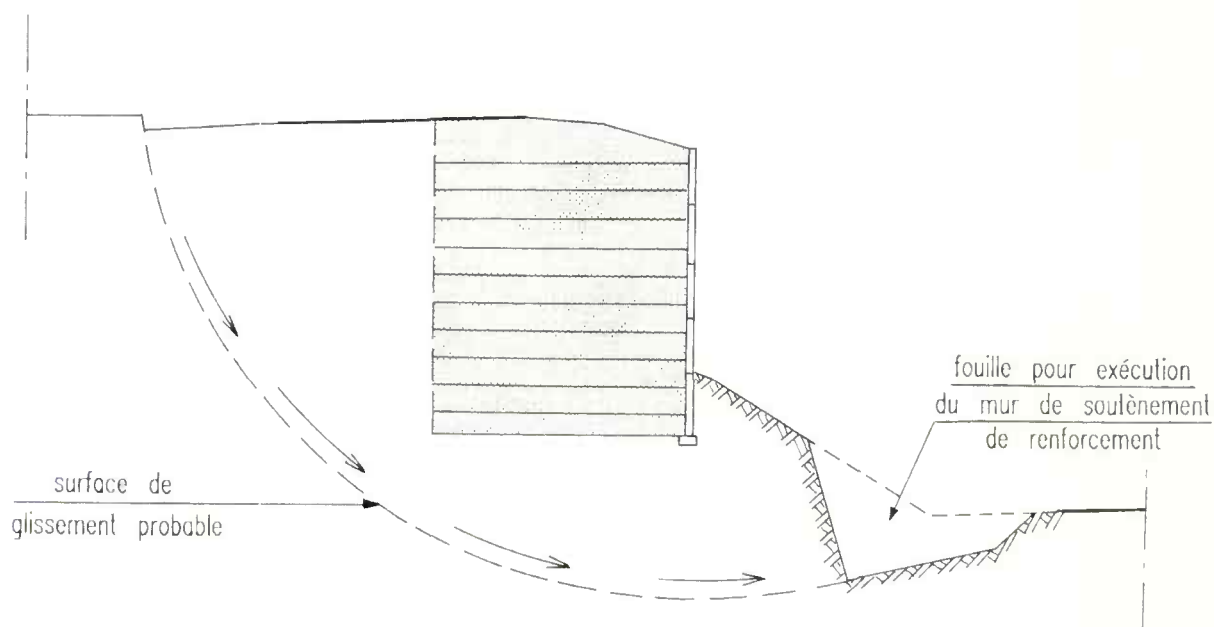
Instabilité lors de l'exécution d'une fouille en pied de l'ouvrage existant
